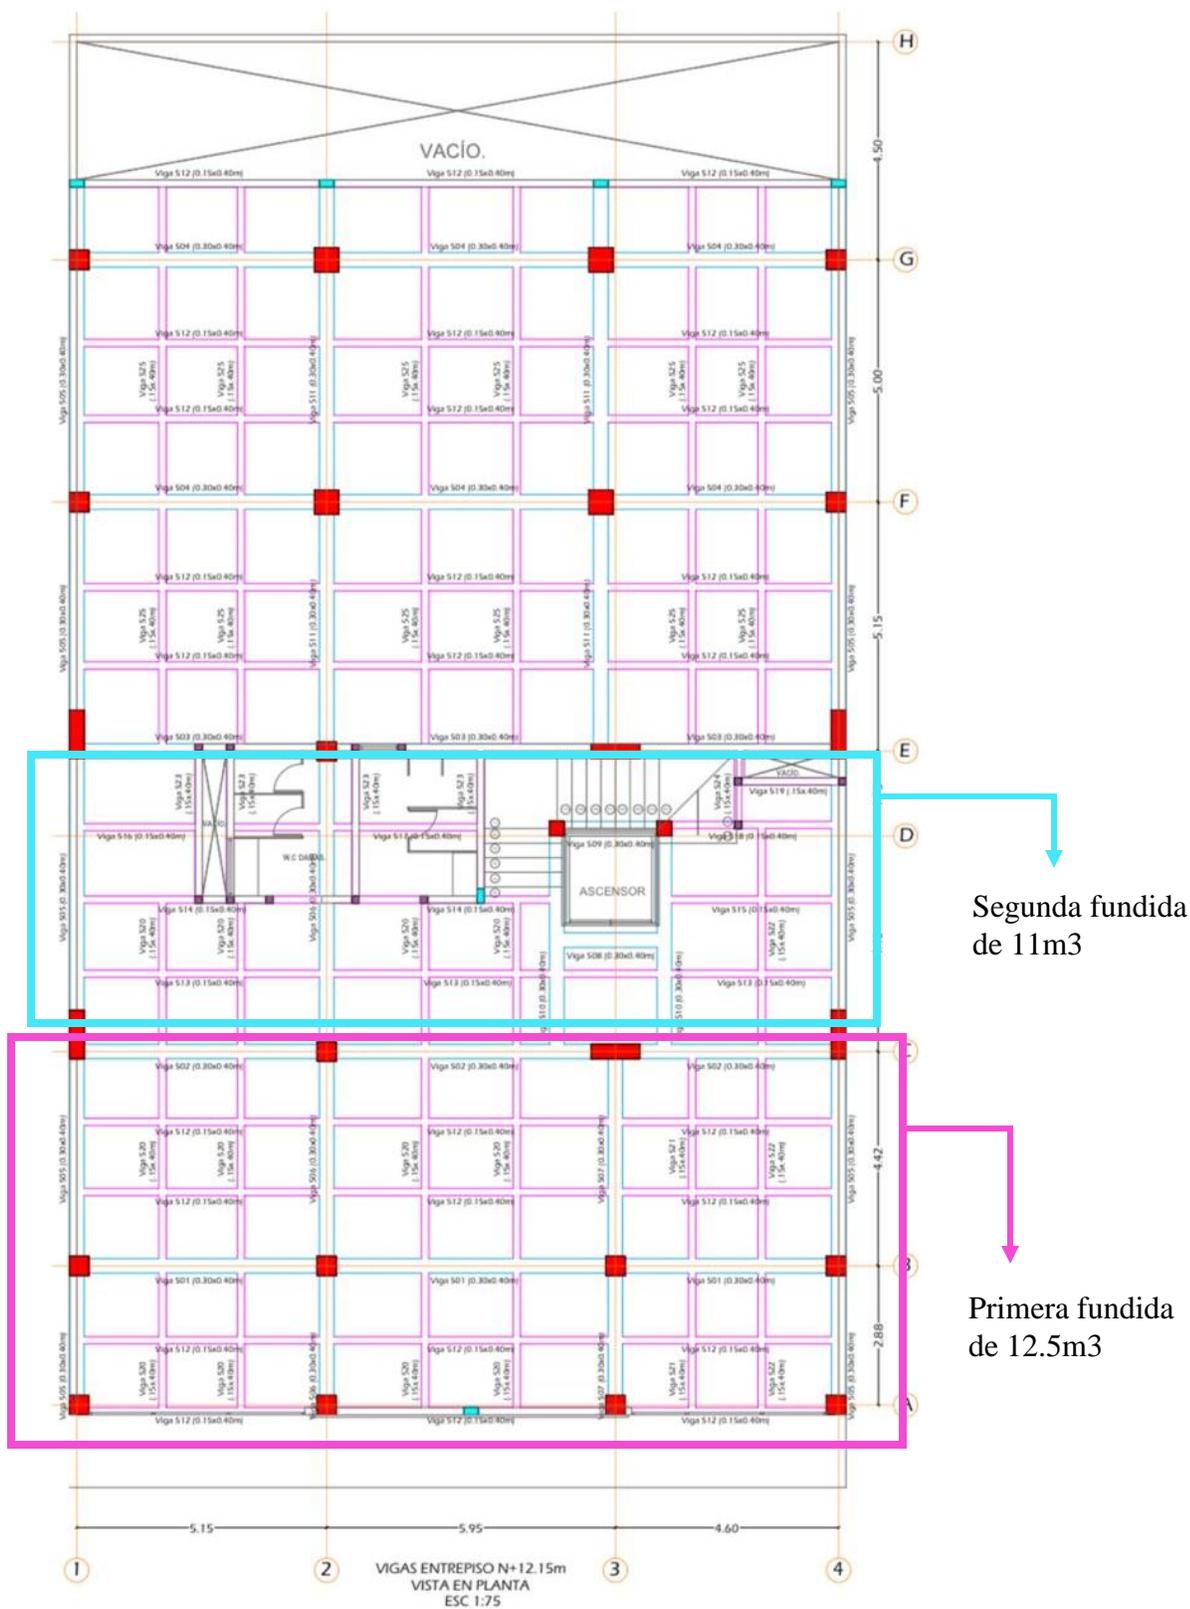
Vista en planta Edificio estructural Wiedii nivel 5
